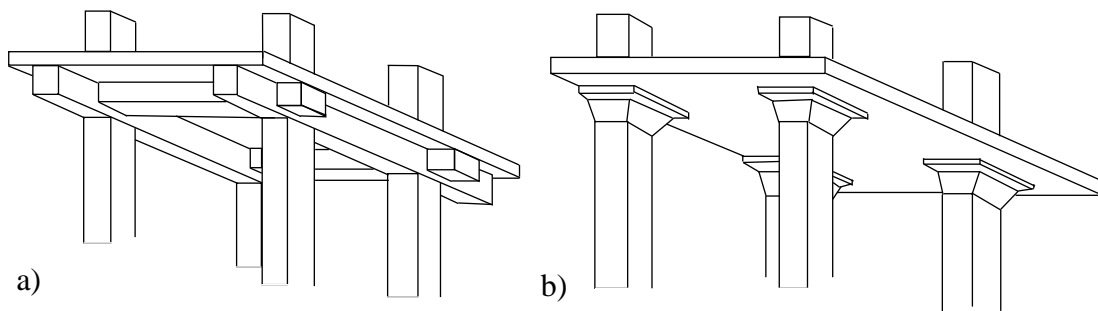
Losas planas apoyadas sobre vigas (a) y ábacos y capiteles (b)
